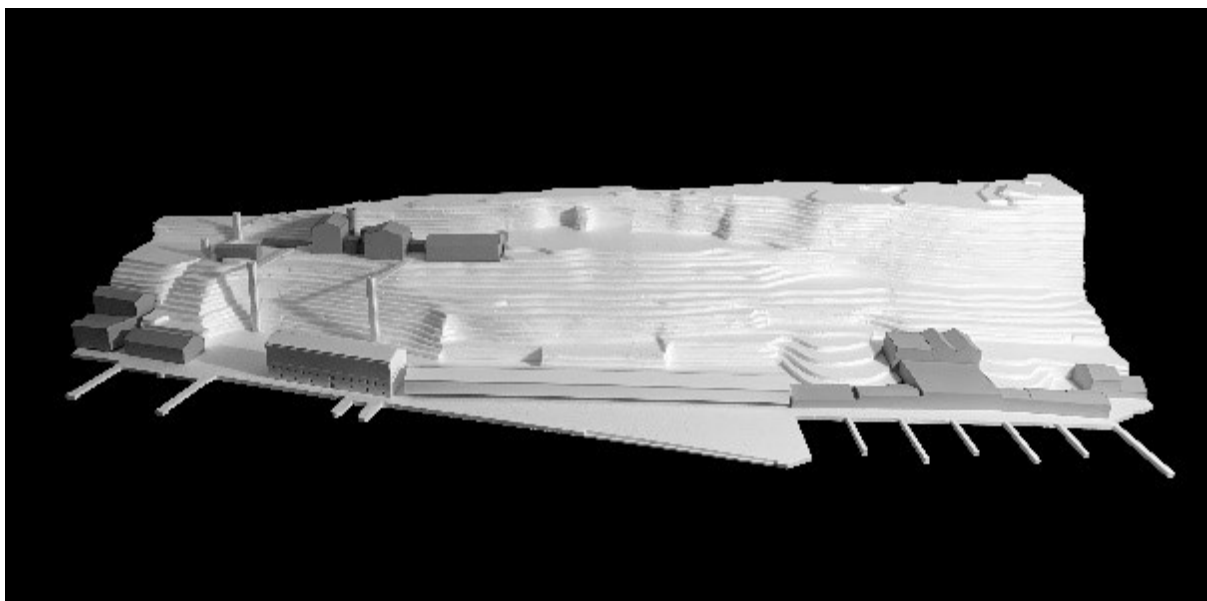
Maquete - Estudo do posicionamento dos elevadores
